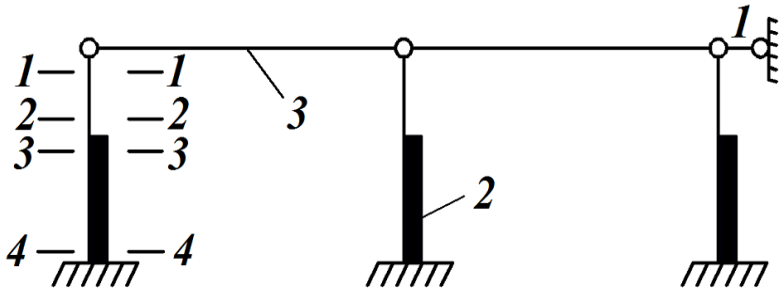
Основна система для розрахунку рами методом переміщень: 1 – введена додаткова опора, 2 – колона, 3 – ригель, 1-1, 2-2, 3-3, 4-4 – розрахункові перерізи колони [11, рис.4.9]
